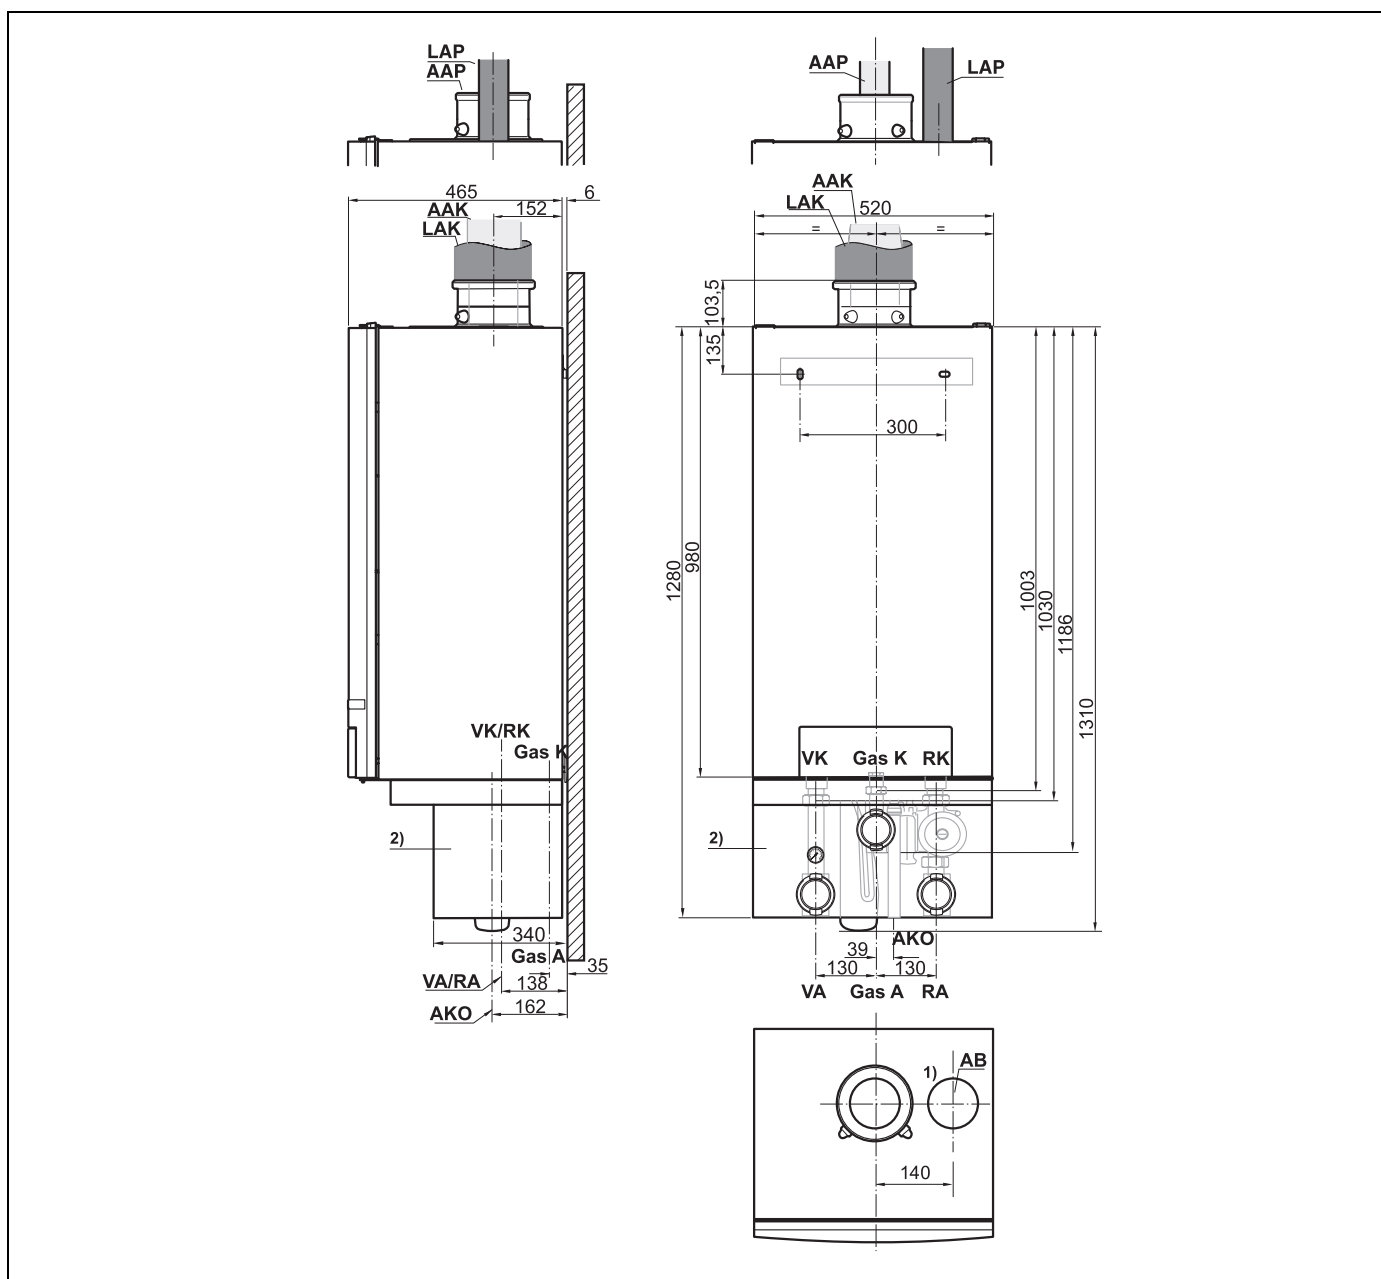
Dimensioner og tilslutninger med tilslutningsgruppe (mål i mm)
